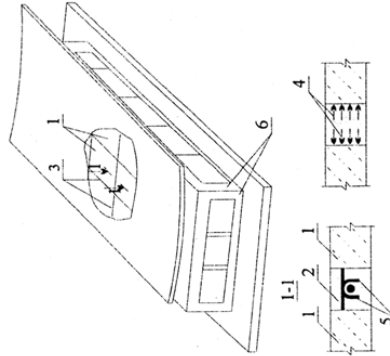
Zapewnienie za pomocą betonu ekspansywnego szczelności przejść przewodów rurowych przez ściany
